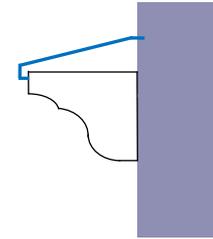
Esquemas de posibles formas de resolución del encuentro entre cornisas y fachada
